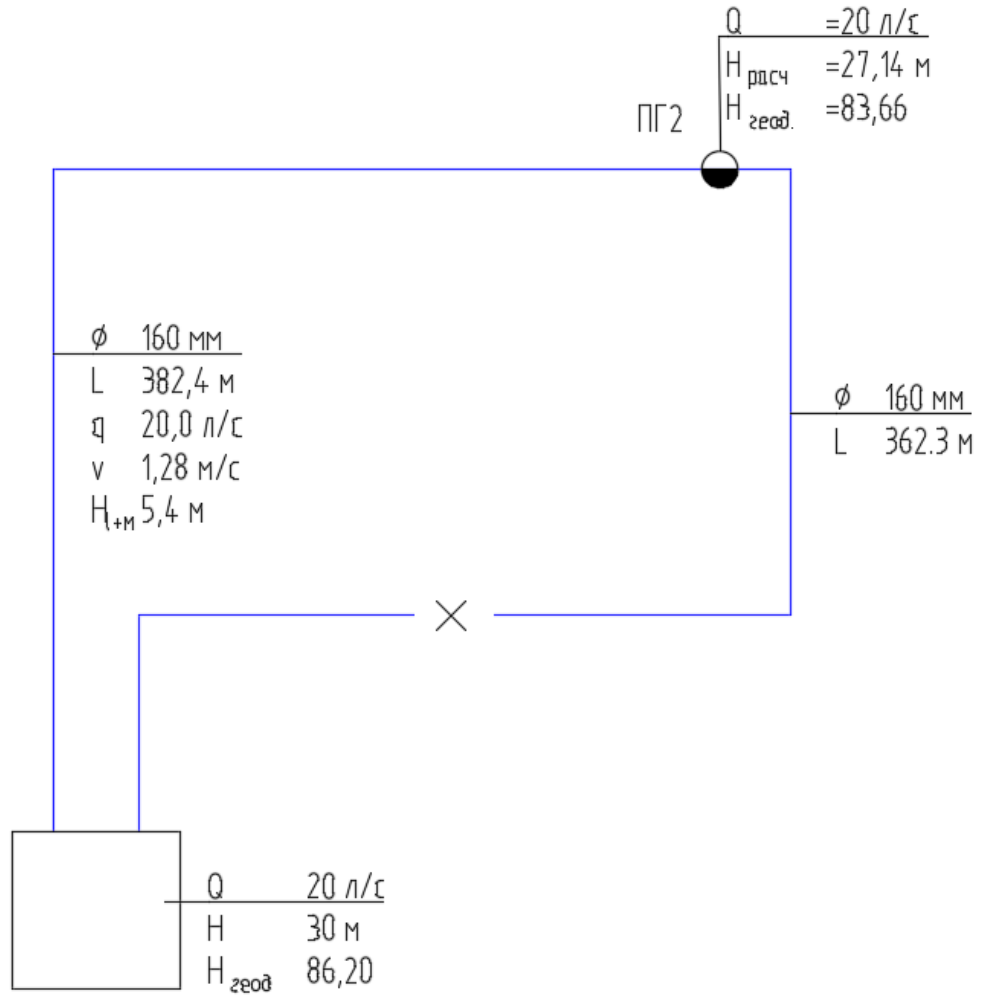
Гидравлический расчет противопожарного водопровода
